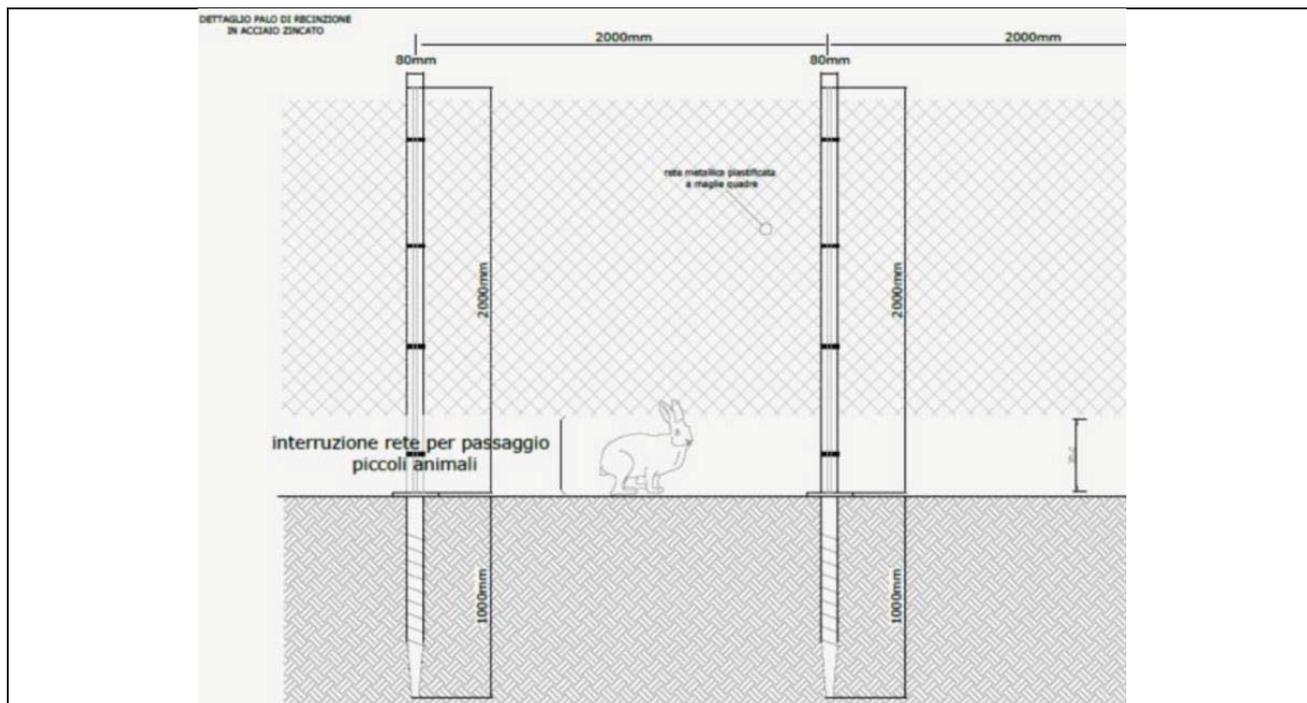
Particolare di uno degli elementi di progetto legati all'intervento di mitigazione (recinzione del corridoio ecologico)
